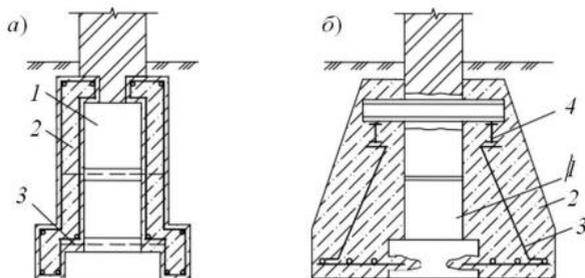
Варианты усиления сборных ленточных фундаментов с помощью: а – горизонтальных штраб и монолитной обоймы; б – металлического каркаса и монолитной обоймы; 1 – фундамент; 2 – обойма; 3 – арматурные стержни.
